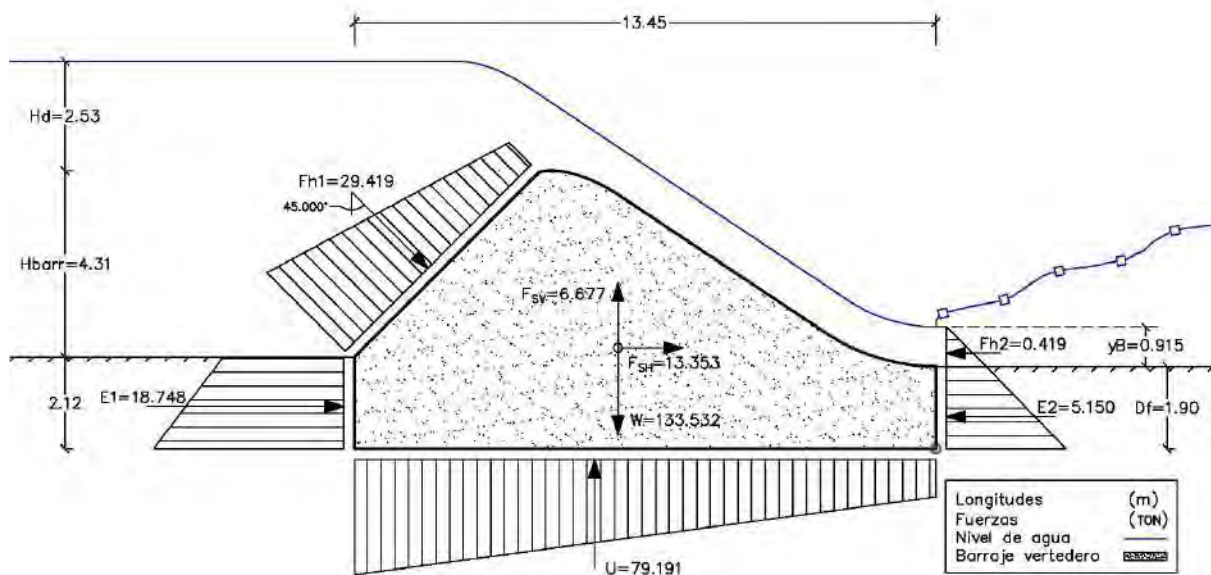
Dimensiones de barrage fijo. Fuente: Elaboración propia.
